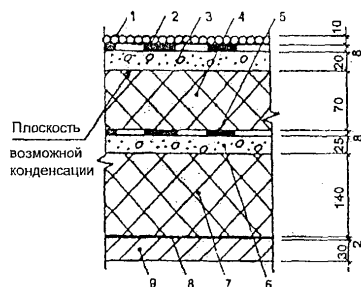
Конструкция покрытия с дополнительным слоем теплоизоляции:
